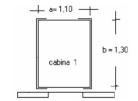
Dimensión de cabina. Fuente: Instalaciones electromecánicas
